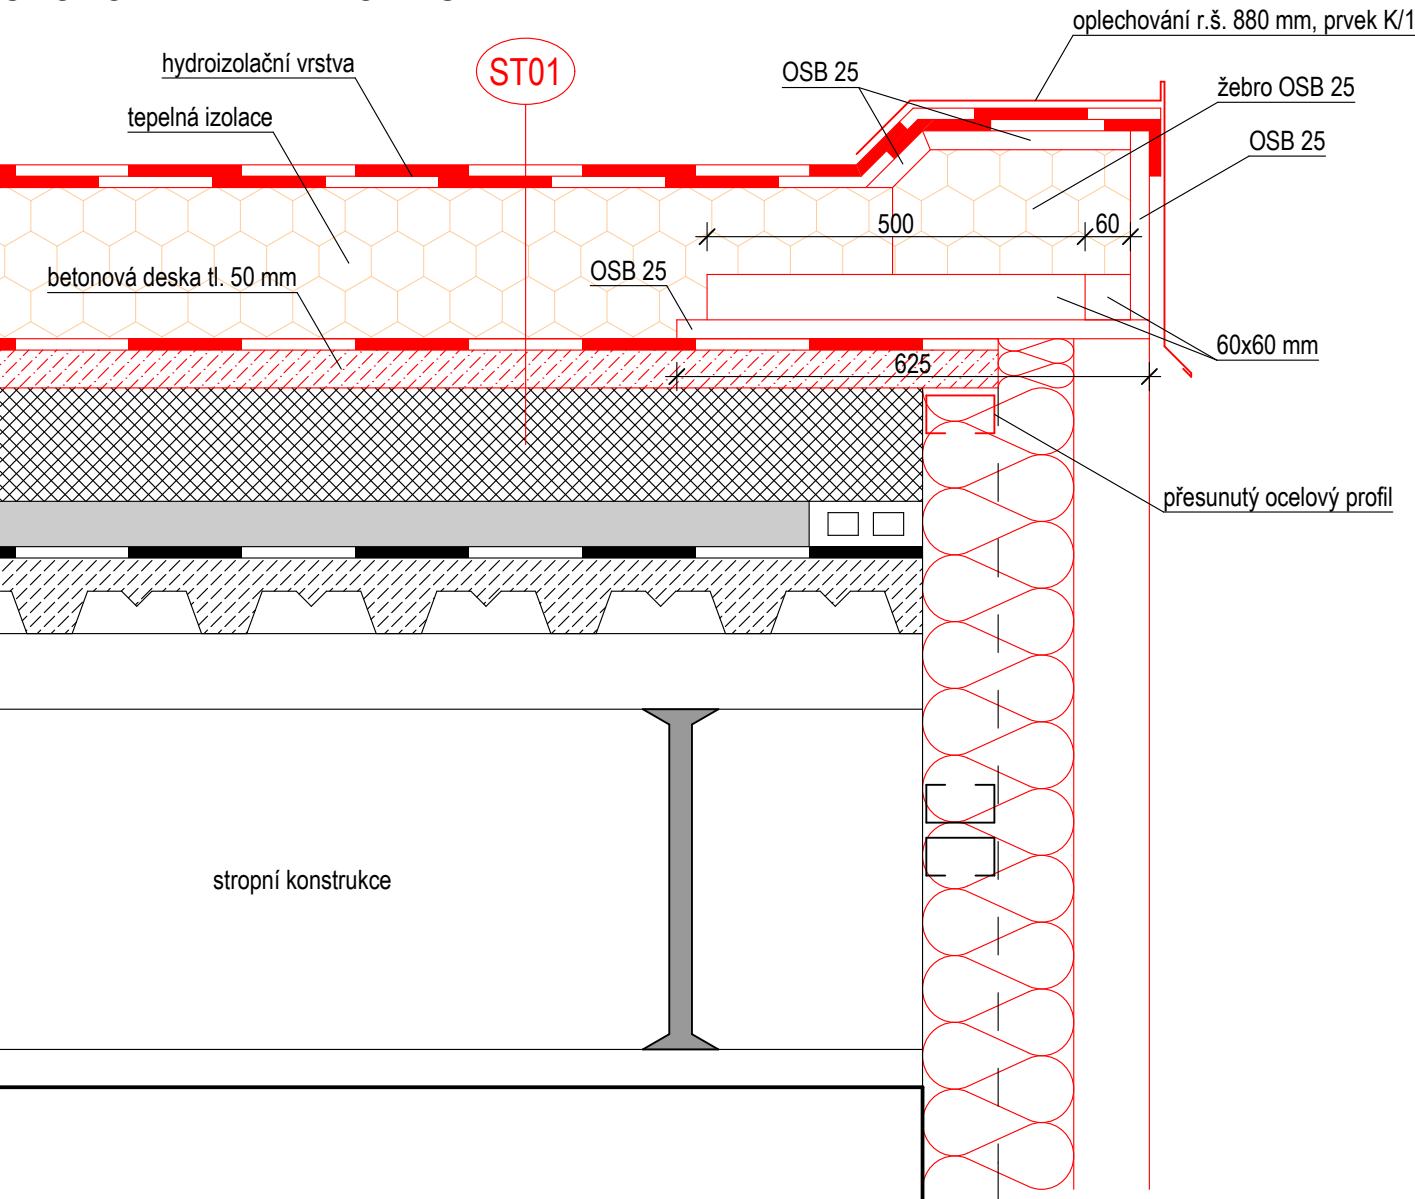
ATIKA NAD SYSTÉMOVÝM OPLÁŠTĚNÍM (PAVILON A, C)
